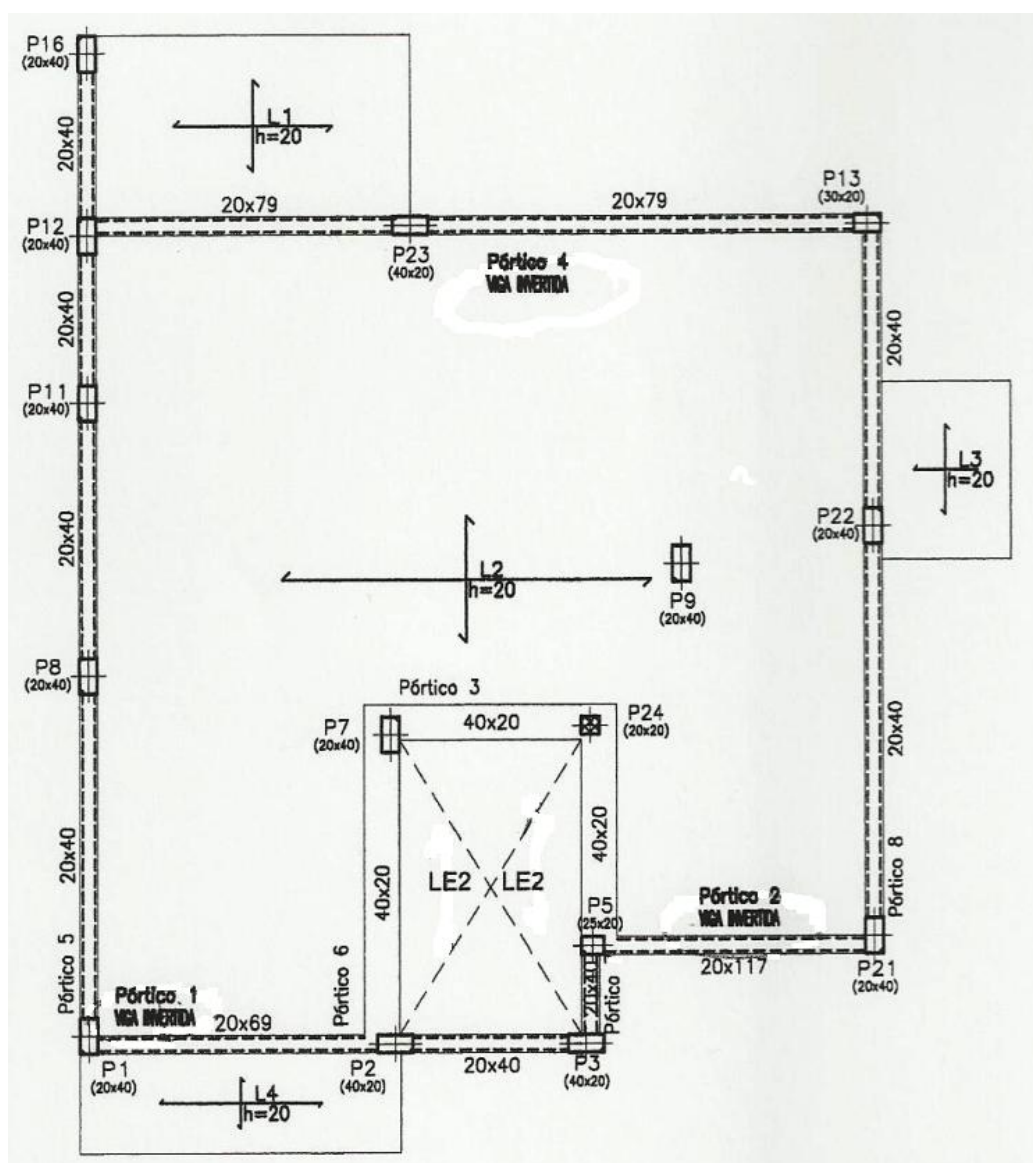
Projeto de Estabilidade – Planta do Teto do Primeiro Piso
